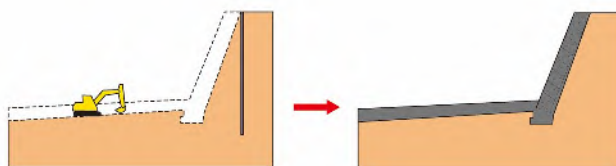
平面構造（擁壁工）の施工概要（イメージ図）
